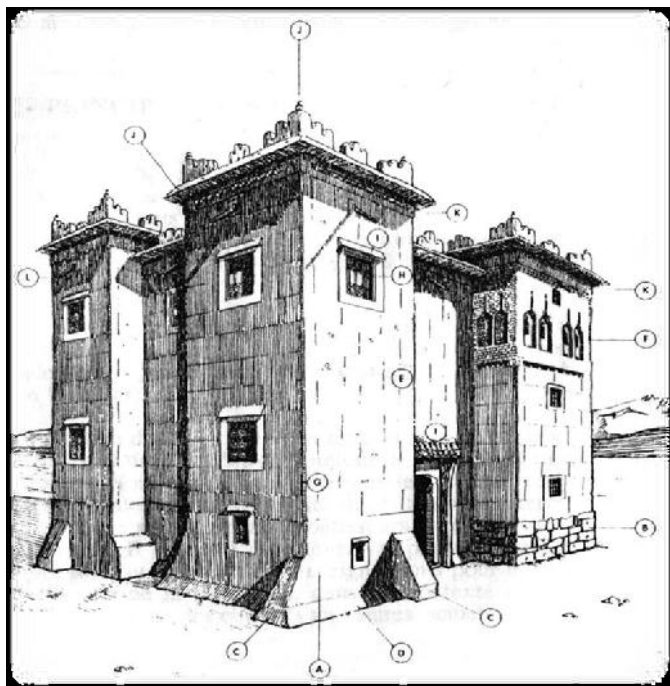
Le schéma de bonne conception architecturale d'un bâtiment en terre [CRATerre].
